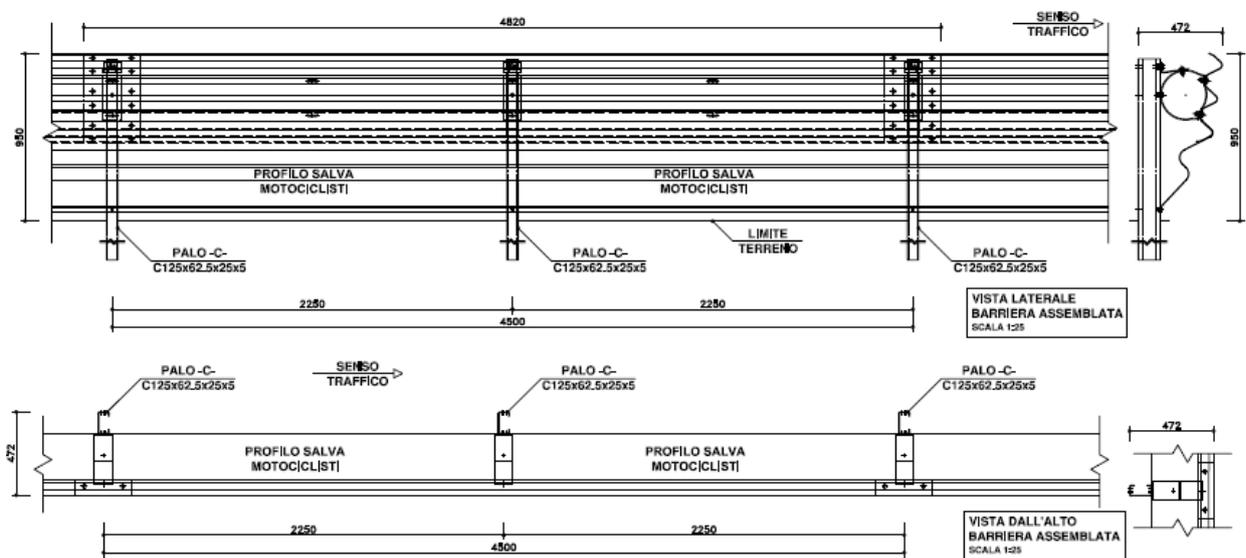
Vista laterale e dall'alto barriera ANAS H2 BLSM
